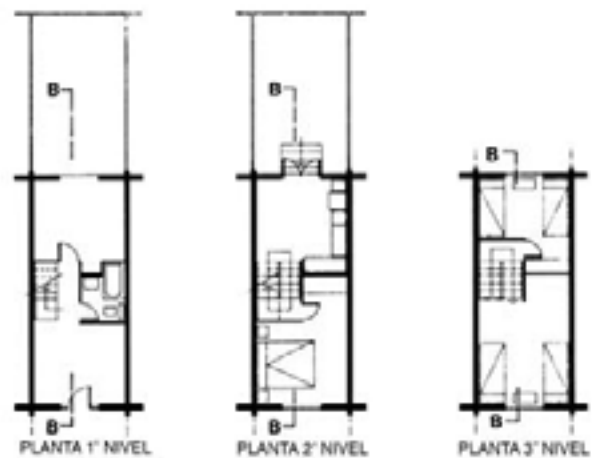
Plantas de arquitectura por nivel. Sin escala.
